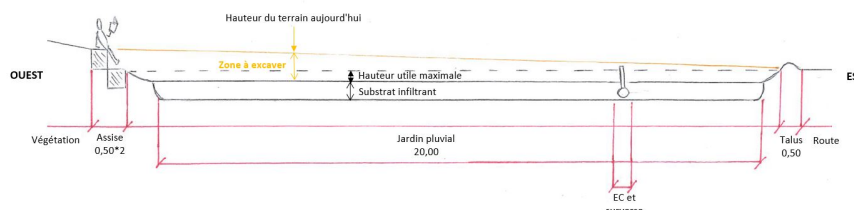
Plan du profil du jardin pluvial de la zone SUD, au niveau de la coupe 1.
